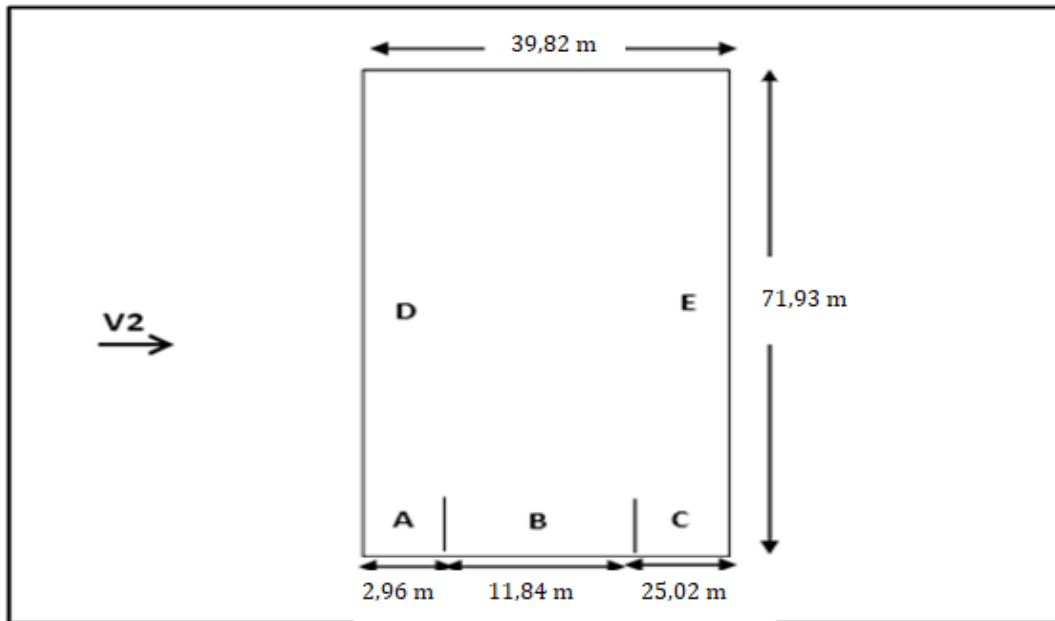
Vue en plan des zones de pression sur les parois verticales sens V2 .
